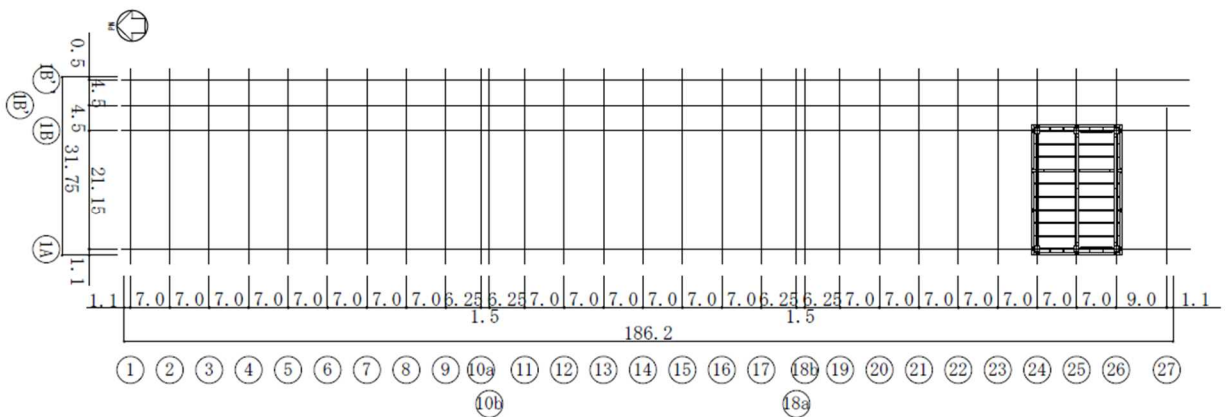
(4) 屋上階平面図 (G. L. +22.850) (単位 : m)
